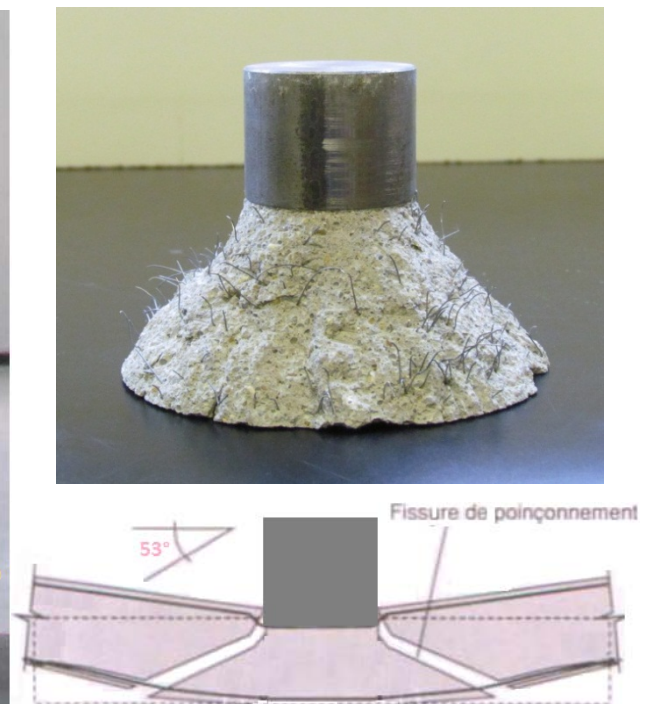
Photo et coupe schématique d'une rupture d'une plaque fibrée saine.
